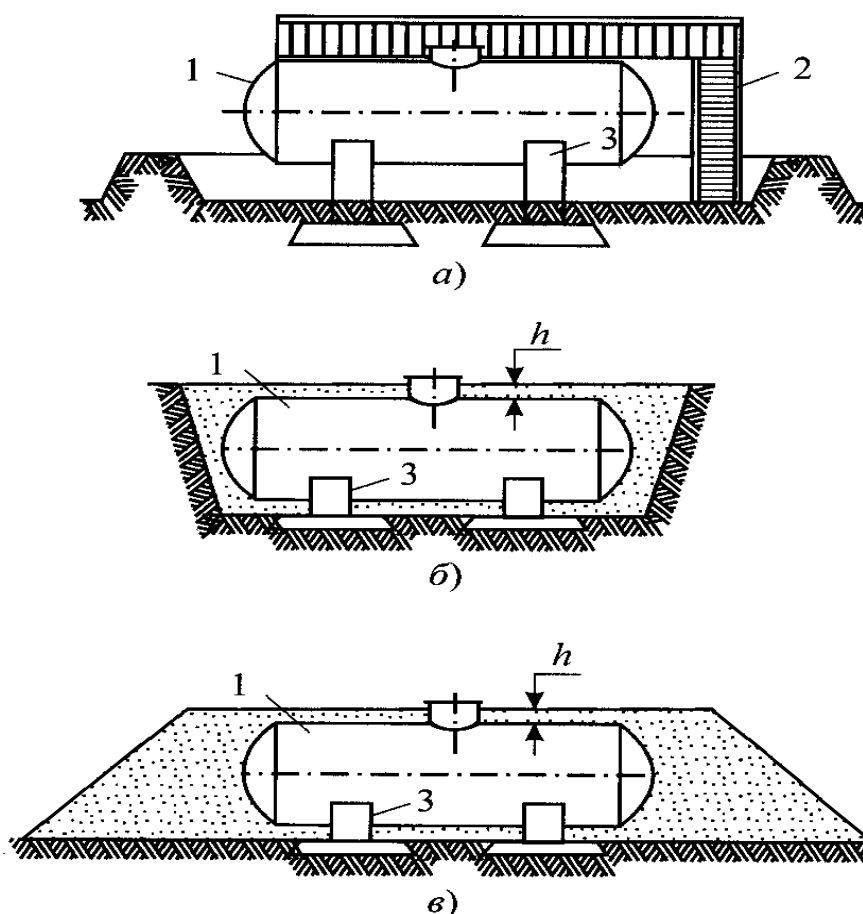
Схемы установки металлических цилиндрических резервуаров:
